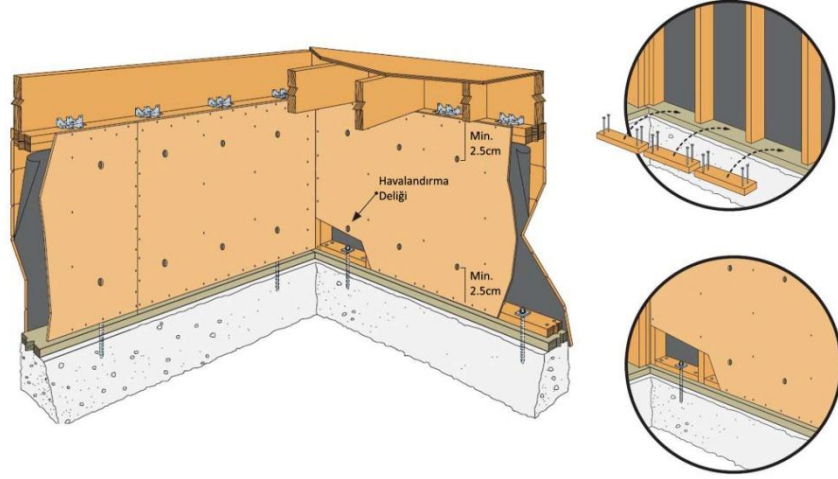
Dikmelerin, kirişe bağlantısında kullanılan bağlantı ürünleri [65], [69]
